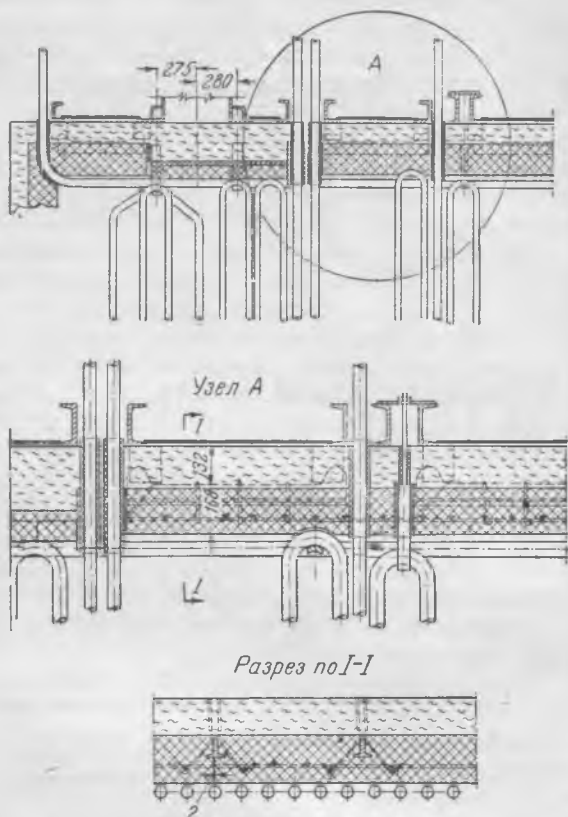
Горизонтальное перекрытие из огнеупорного бетона для котла ТП-170.
